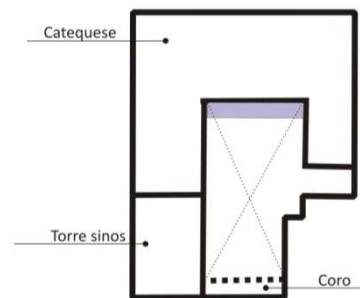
Planta esquemática do 1º Pavimento do antigo santuário. Fonte: NOGUEIRA, 2006, p.63.
